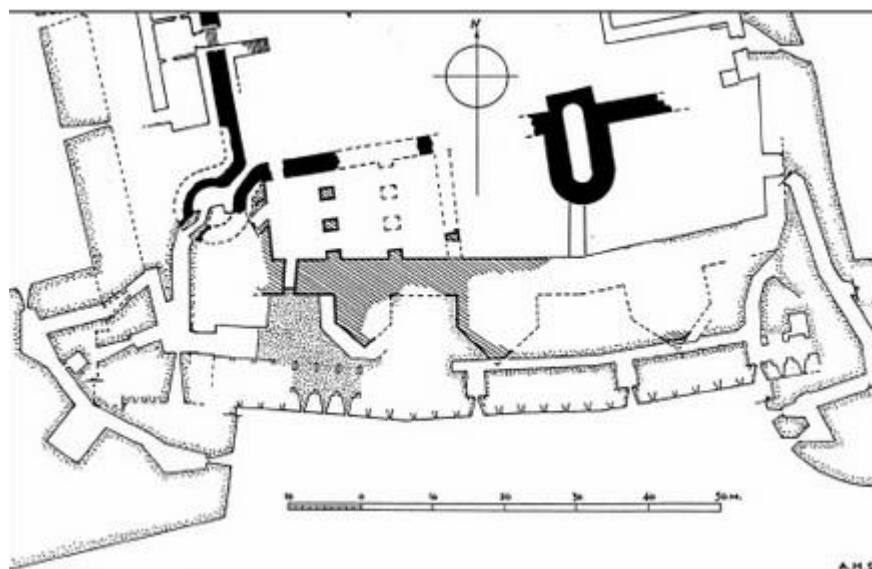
Plan du Château de Kerynia, Secteur Sud-Ouest, par Tassos Papacostas<sup>1371</sup>.
